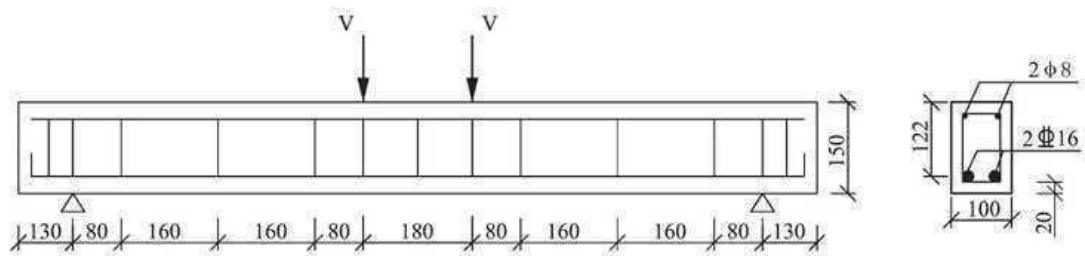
Dimensions et détails de ferrailage des poutres [50].
